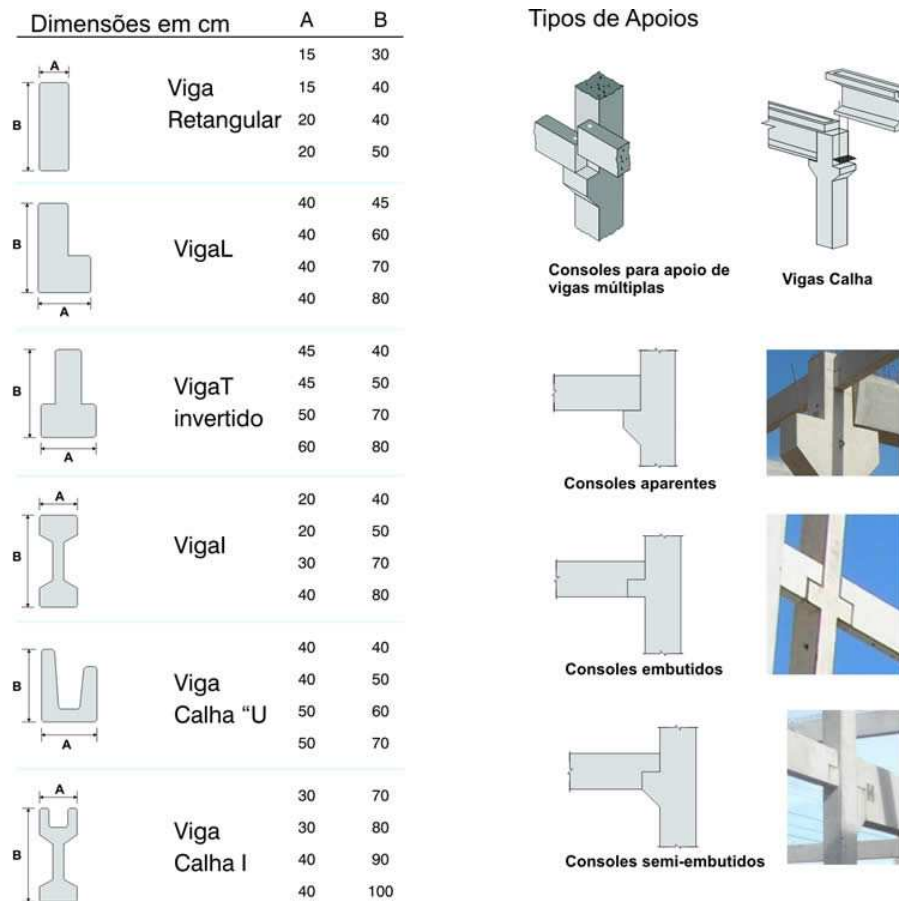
Exemplo de seções padronizadas de vigas pré-moldadas
